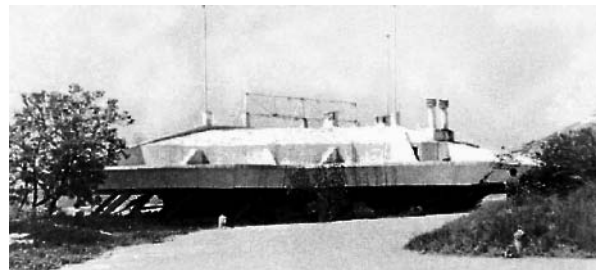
Restaurant « La Réserve », façade Est, après le tremblement de terre.
